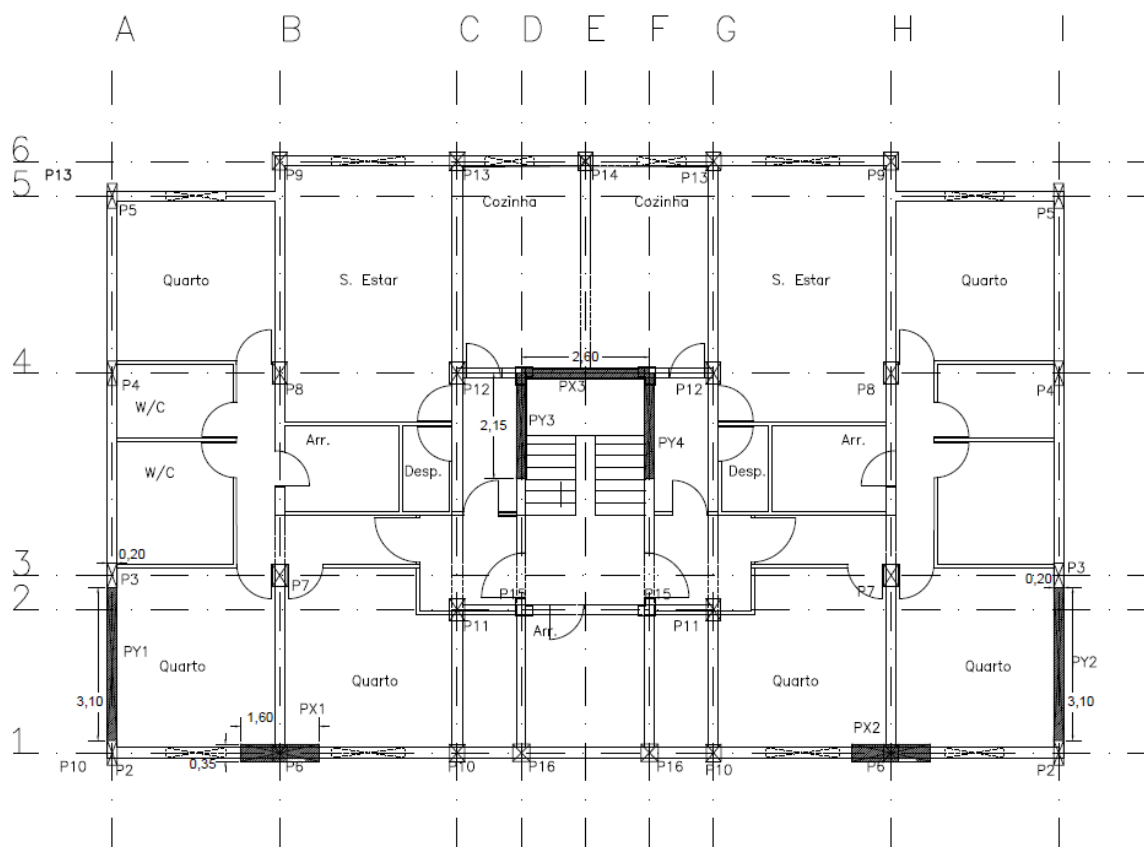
Planta de reforço - limitações arquitetónicas
